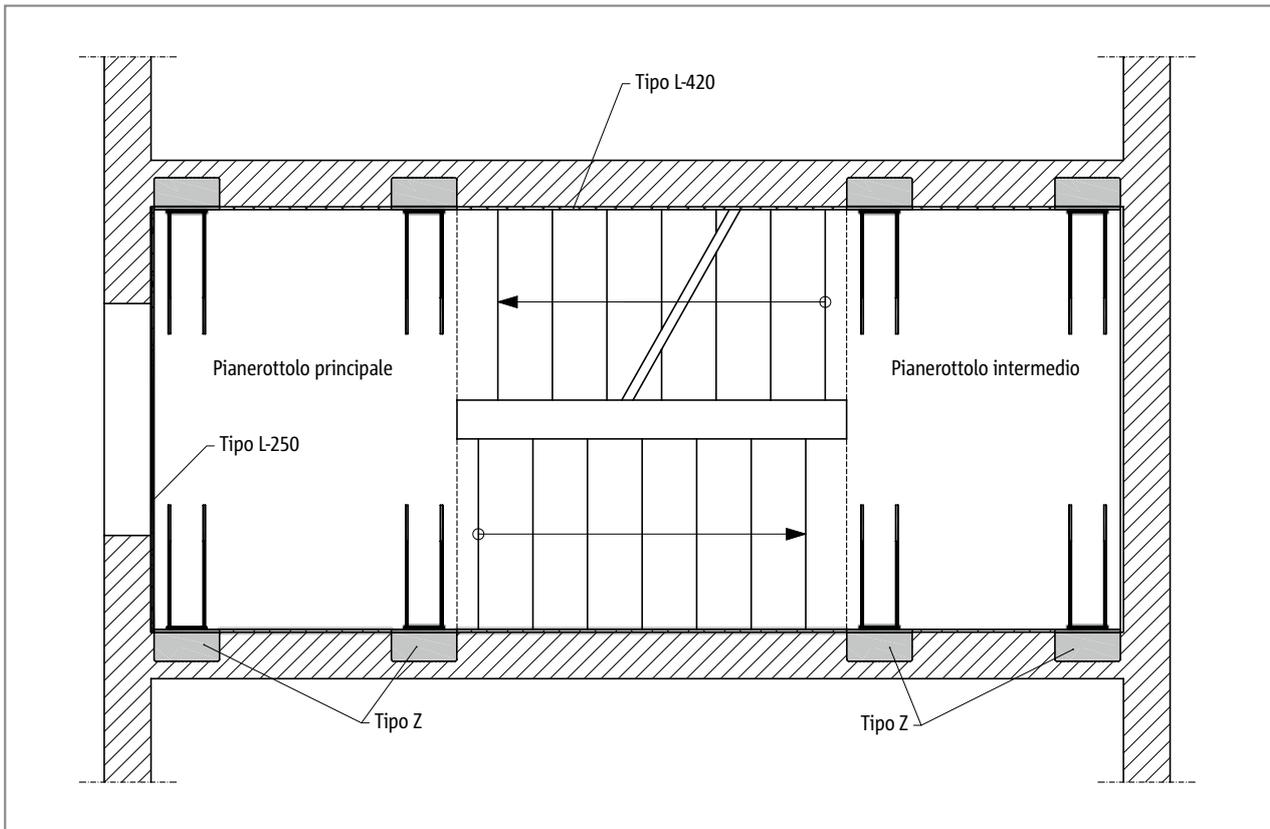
Schöck Tronsole® tipo Z, disposizione dell'elemento nella pianta
